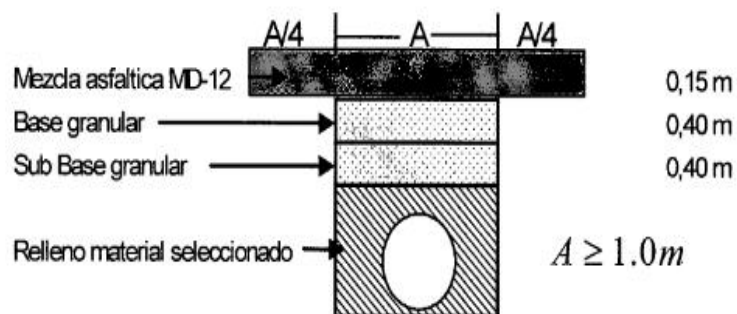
Estructura tipo de pavimento flexible, para intervenciones en zanja sobre vías locales
